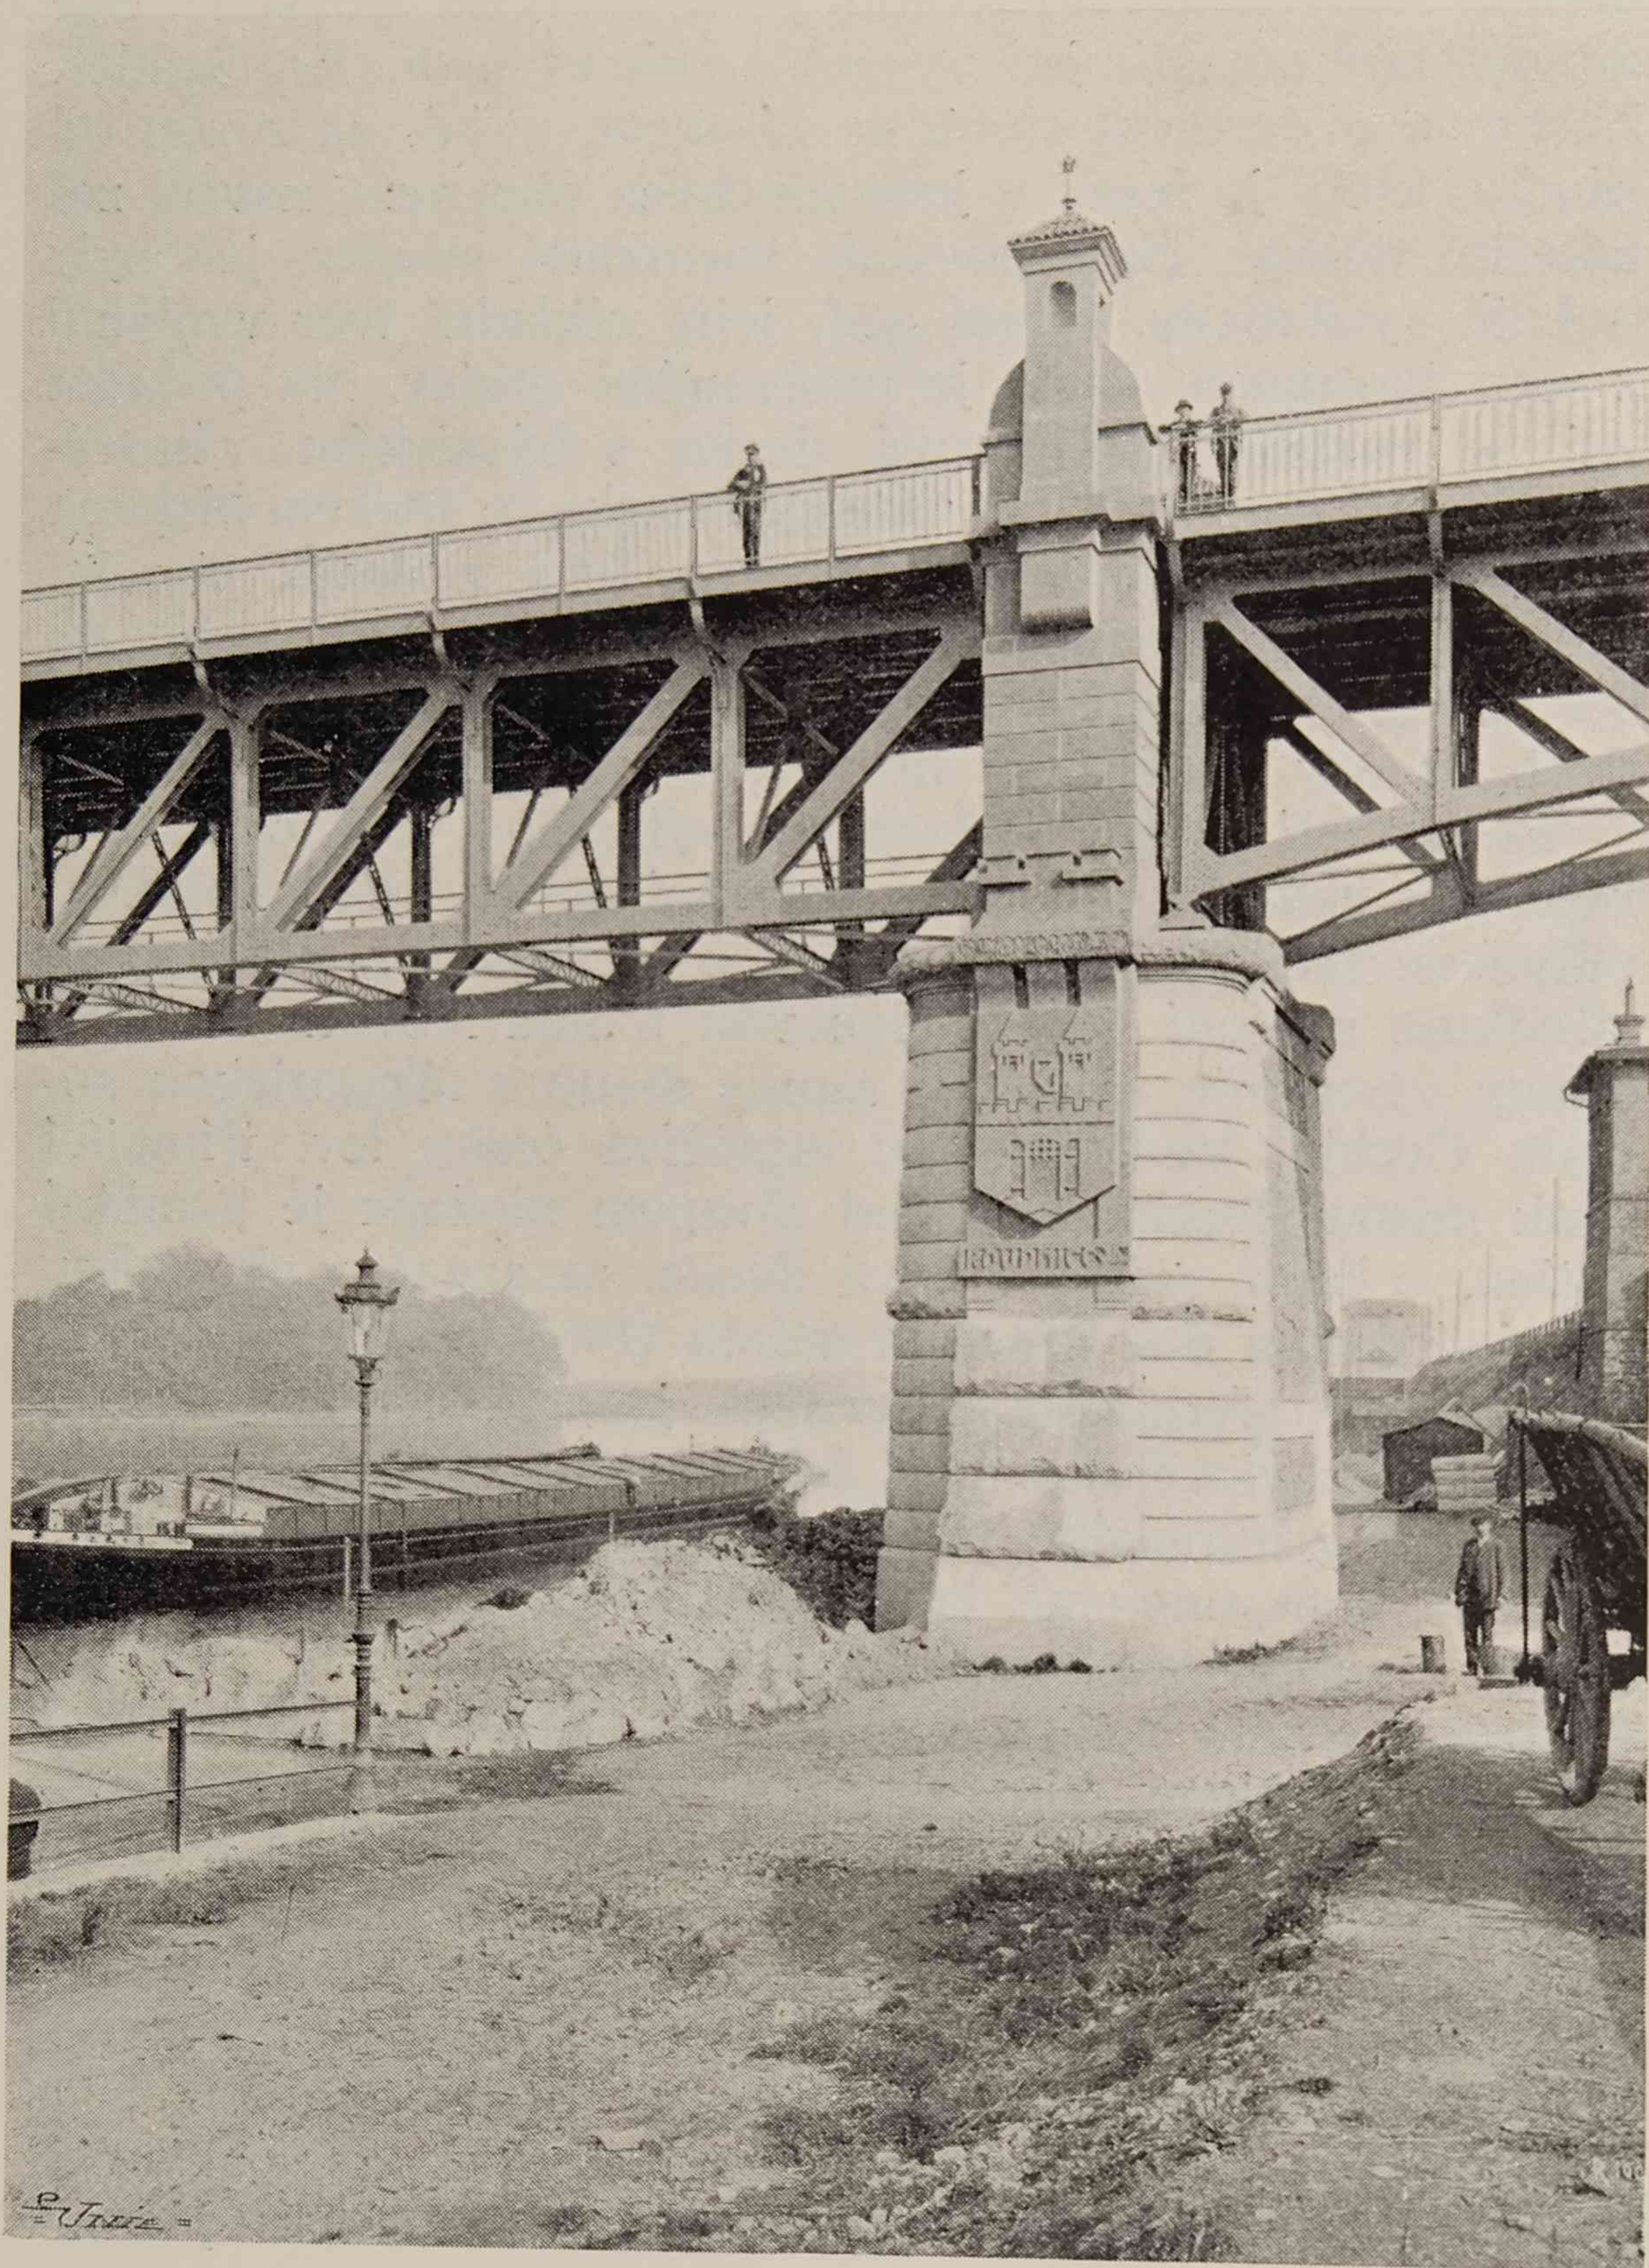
Základ pravého pilíře pobřežního čís. 8.
